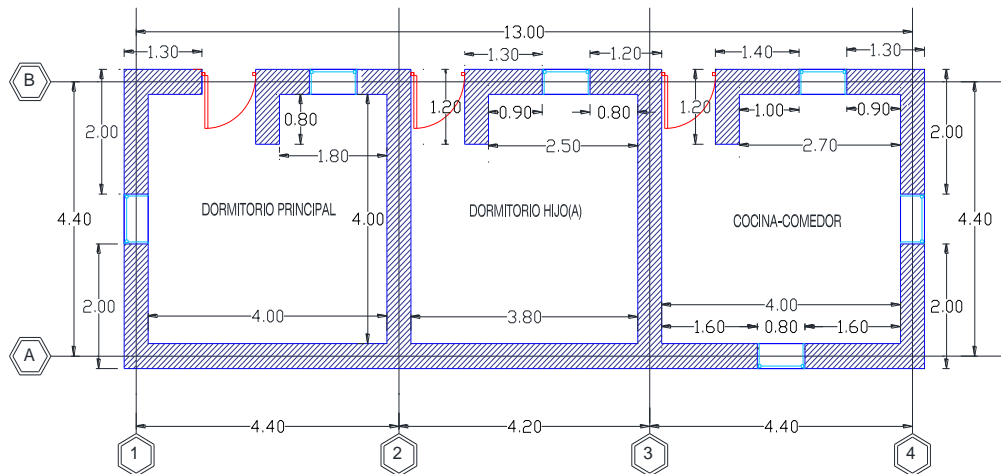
Plano de planta de propuesta de vivienda para tres personas
